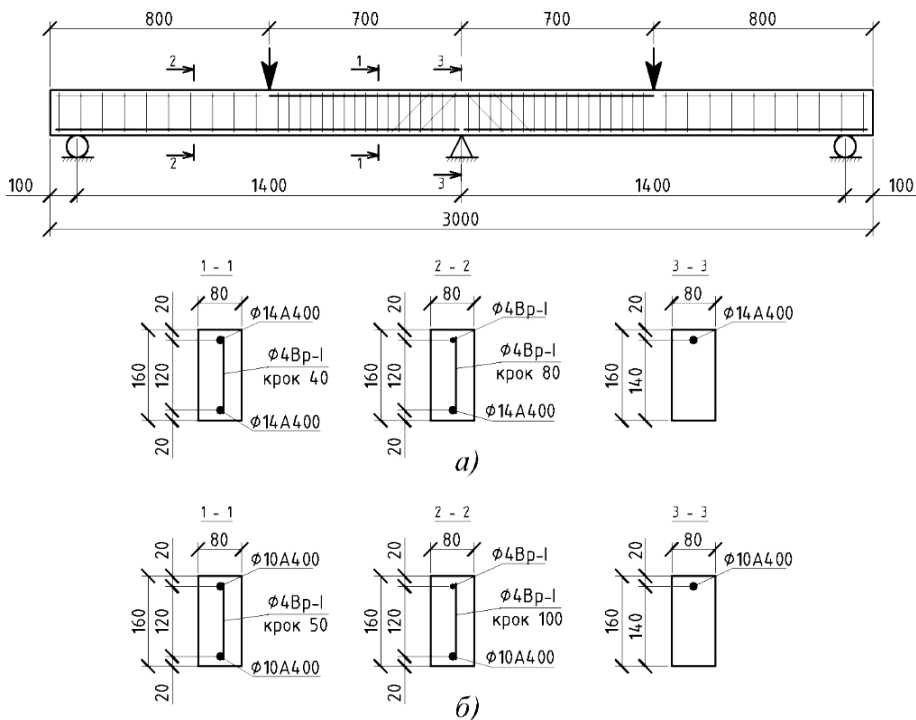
Конструктивна схема дослідних балок. а) армування ЗБ балок; б) армування СФЗБ балок
